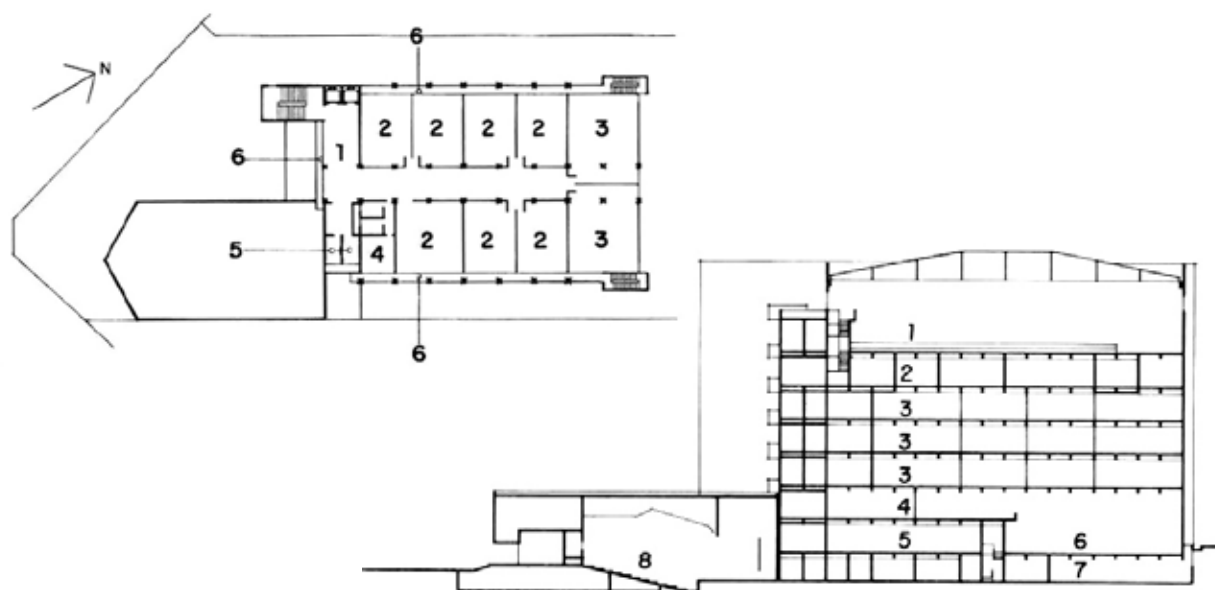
SESC da Esquina (Meister e Furman): SESC da Esquina: planta do 4º pavimento; 1) hall; 2) sala de aula; 3) sala especial; 4) copa; 5) sanitário; 6) sacada.
